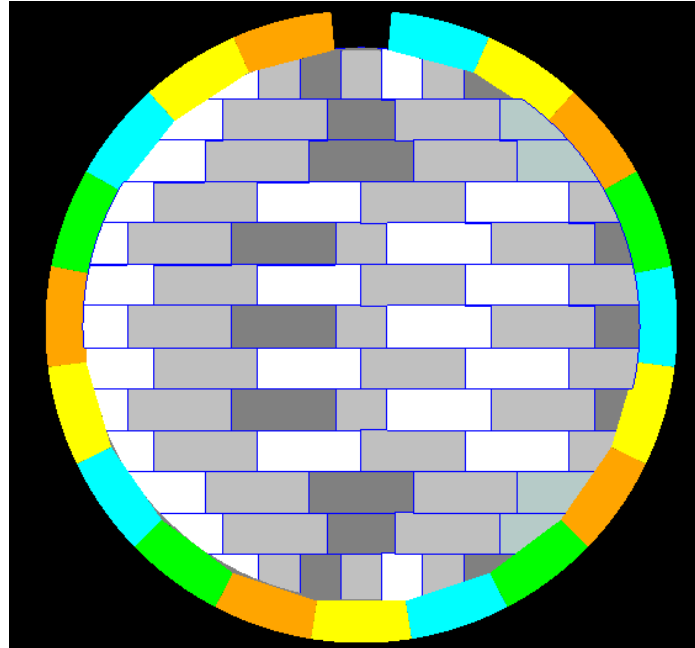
Vista en planta del arreglo de las placas del fondo.
